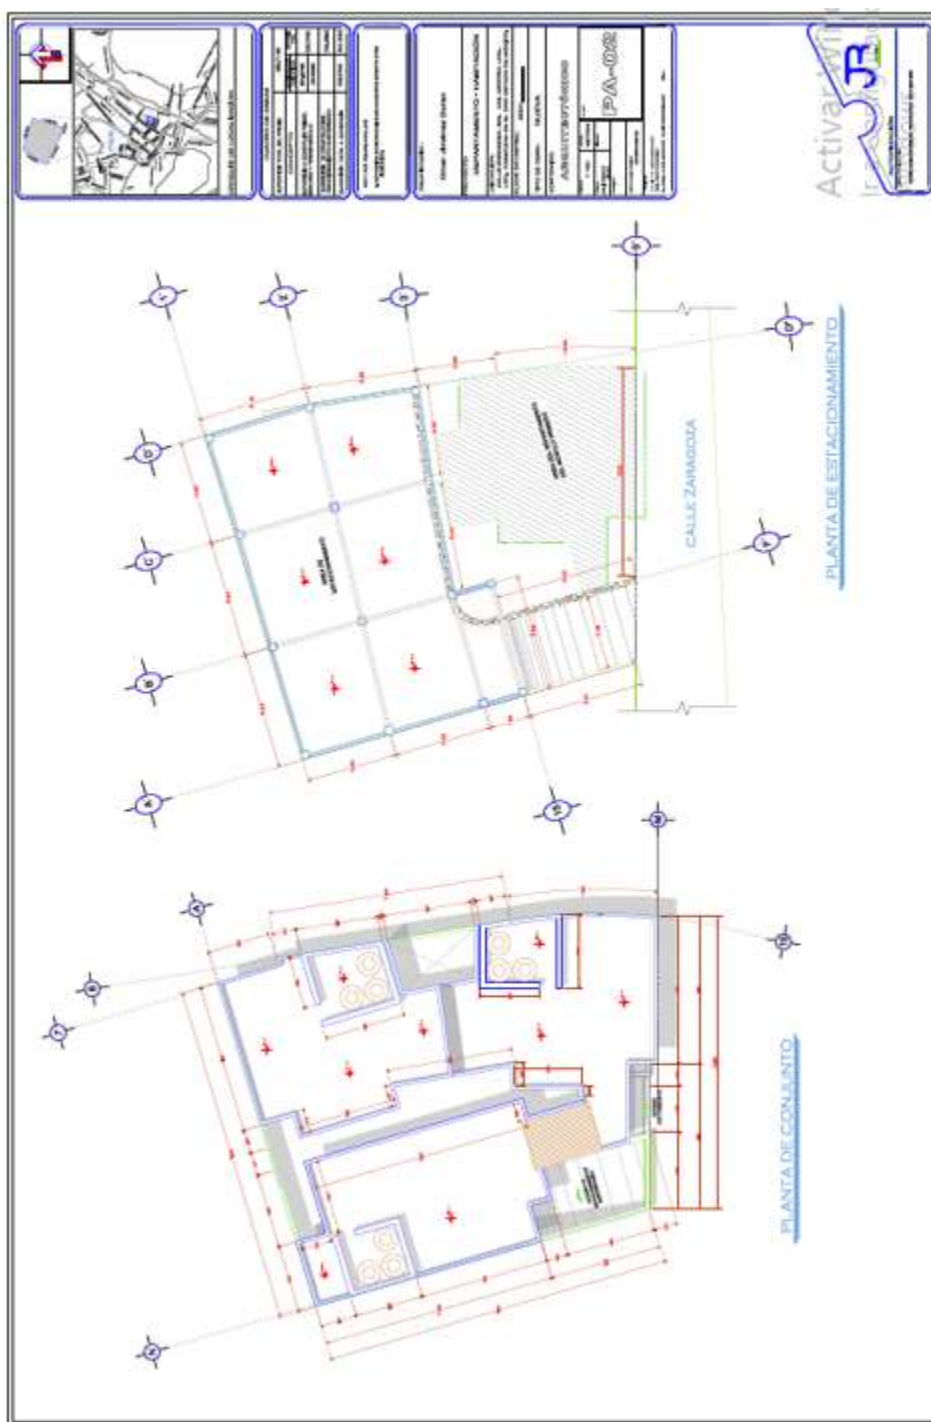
Imagen del plano resultante de vista de Azoteas, así como el despliegue de la distribución de columnas del Estacionamiento Subterráneo, con su respectiva rampa de acceso. También se representa un achurado de la planta del módulo uno, del desplante de los primeros departamentos frontales que colinden con la calle de acceso (Calle Zaragoza).
